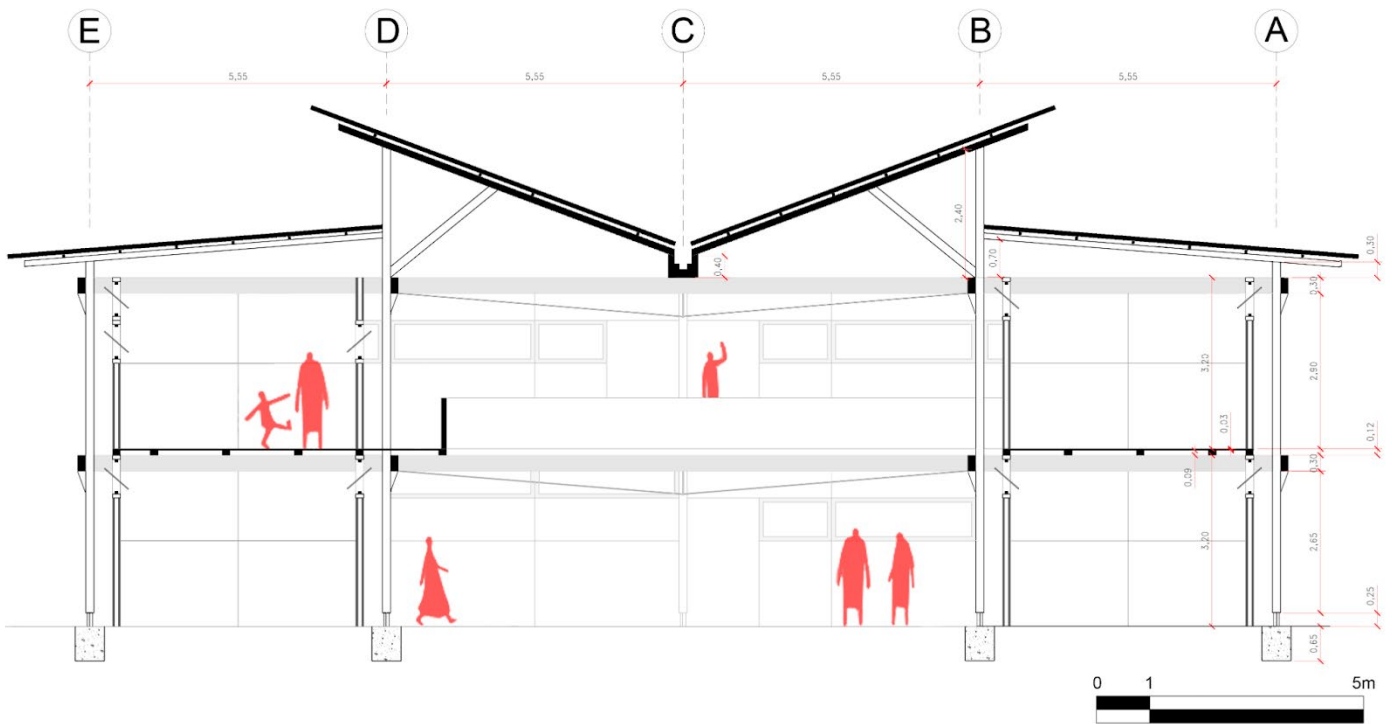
Elevação Oeste / Fonte: Autoria do grupo.
